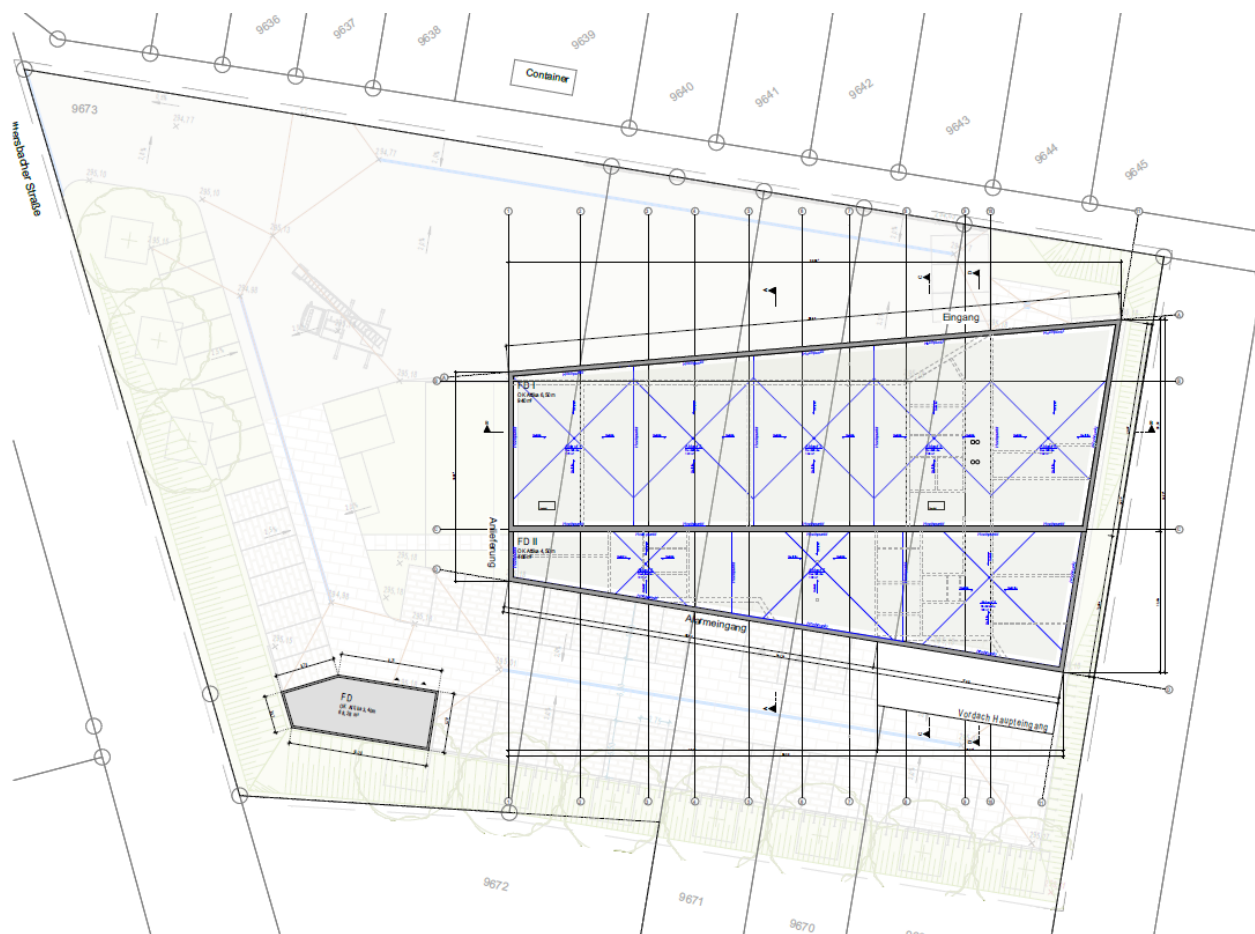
Lageplan Planungsbüro BUEROHAUSER (Stand 26.03.2026)
